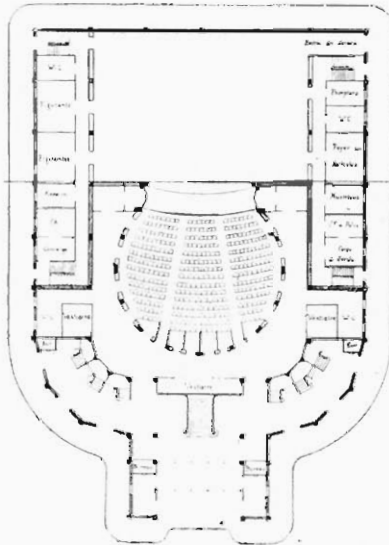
Théâtre Populaire, plan du rez-de-chaussée.
